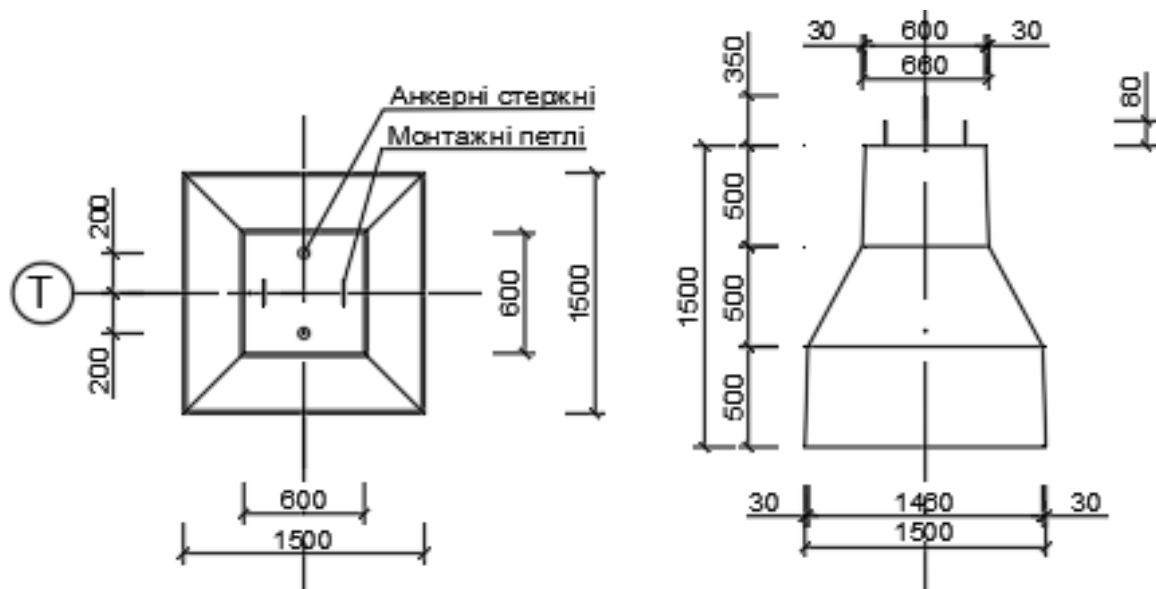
Конструкція збірного залізобетонного фундаменту.
